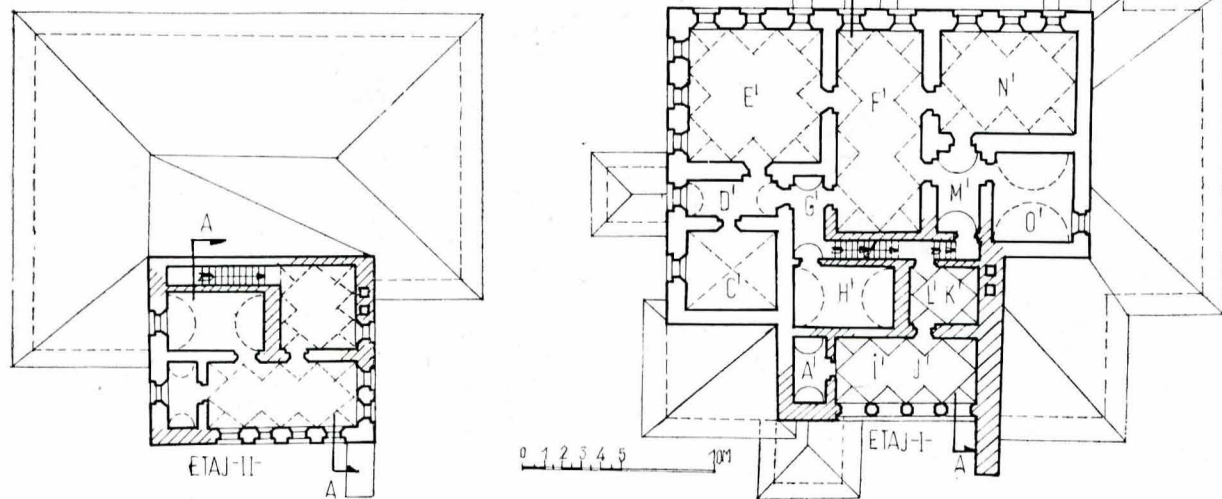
c. Conacul de la Măgureni (plan etaj I și plan etaj II).
